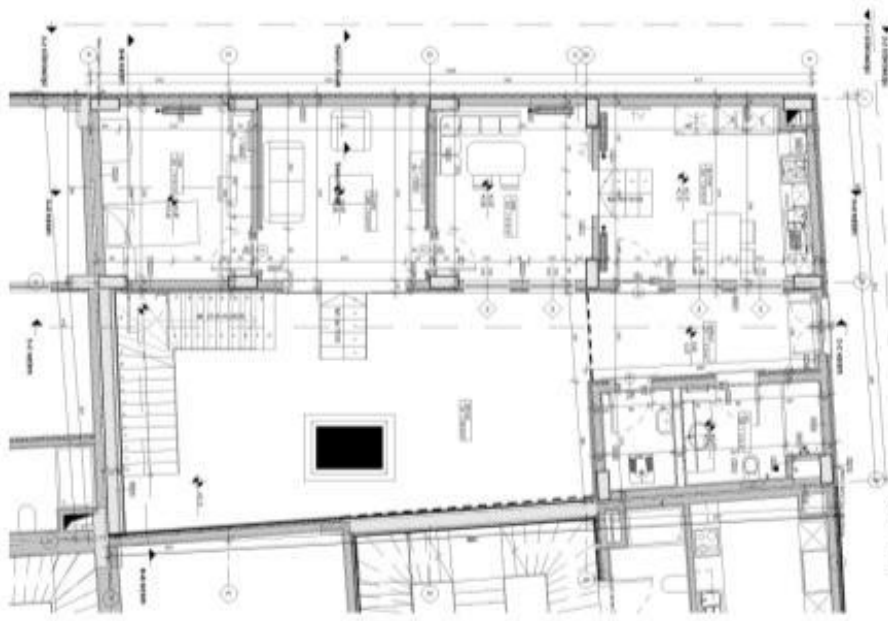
KİPTAŞ tarafından yapılan geleneksel evler vaziyet planı
